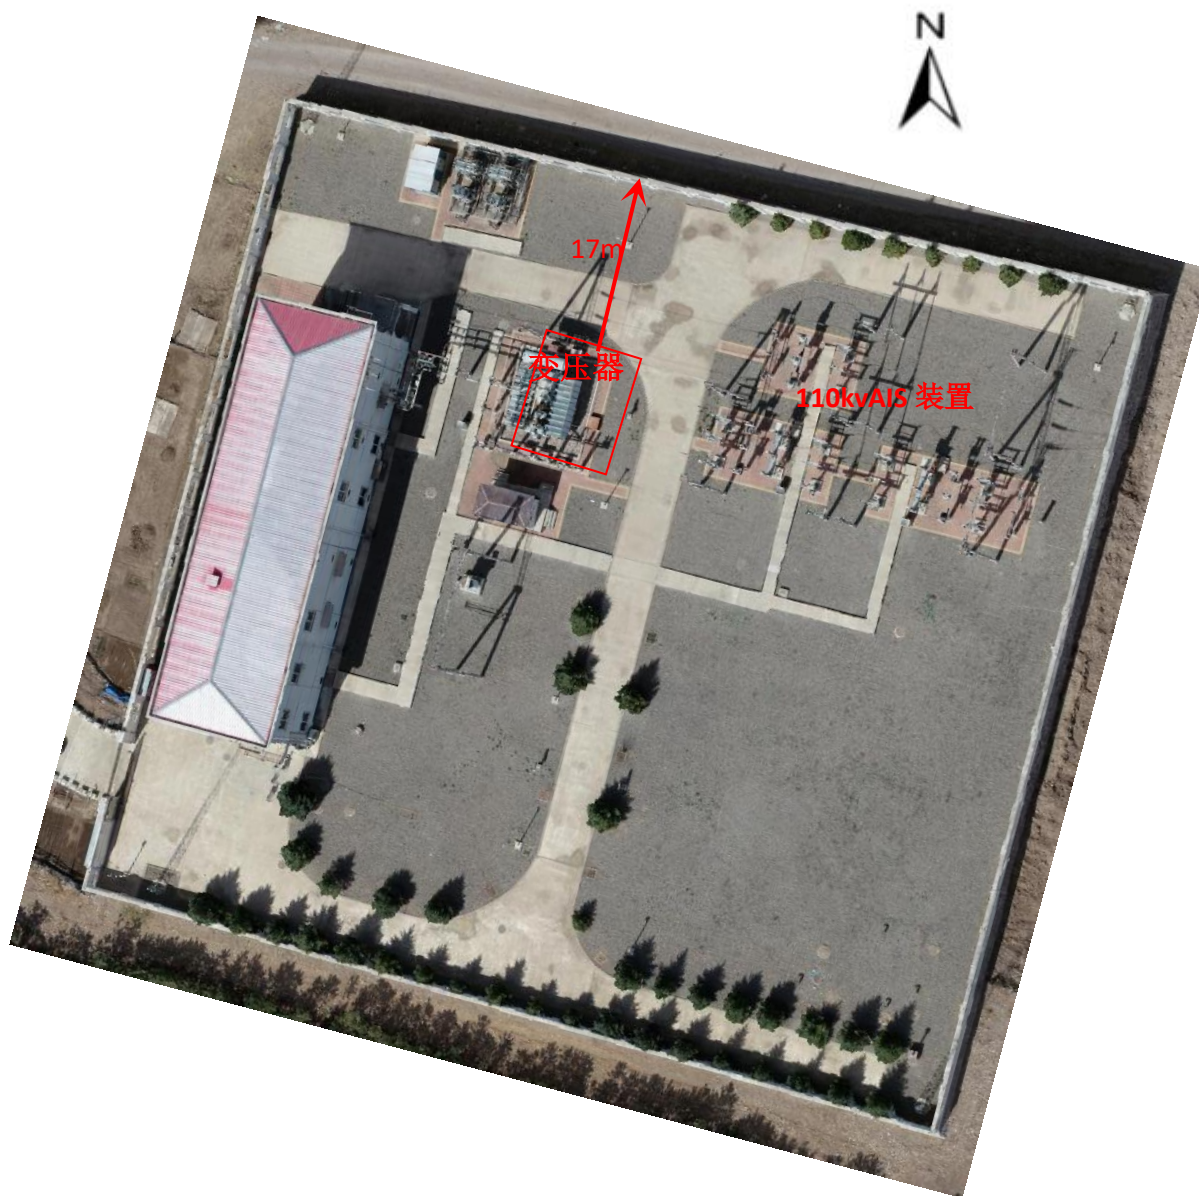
郭家屯 110kV 变电站平面布置图 比例尺 1:940
